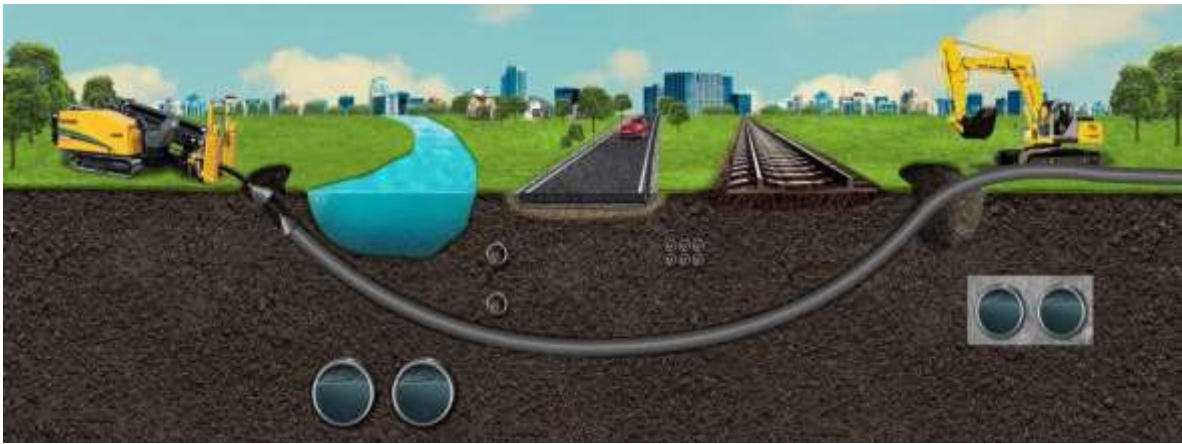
Прокладка трубопроводов методом ГНБ под дорогами и водоемами
